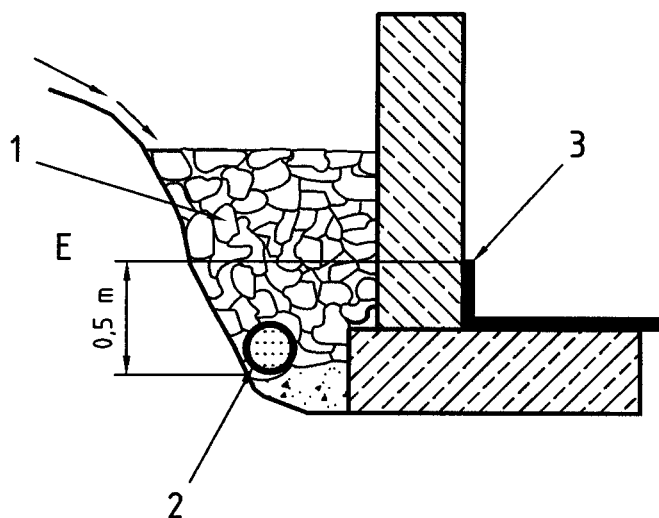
exemples de cas d'eaux de ruissellement ou d'infiltration avec drainage sans revêtement
